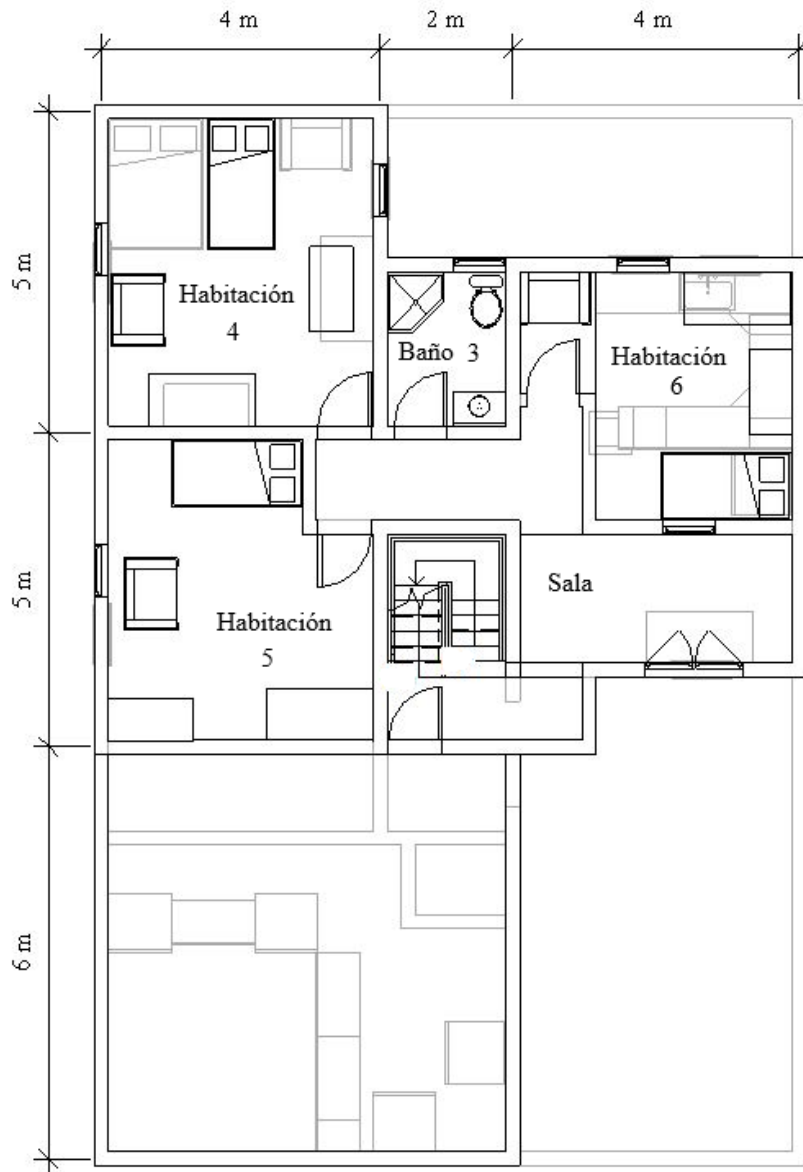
Plano arquitectónico de la edificación en la Ciudad de México, planta alta.
